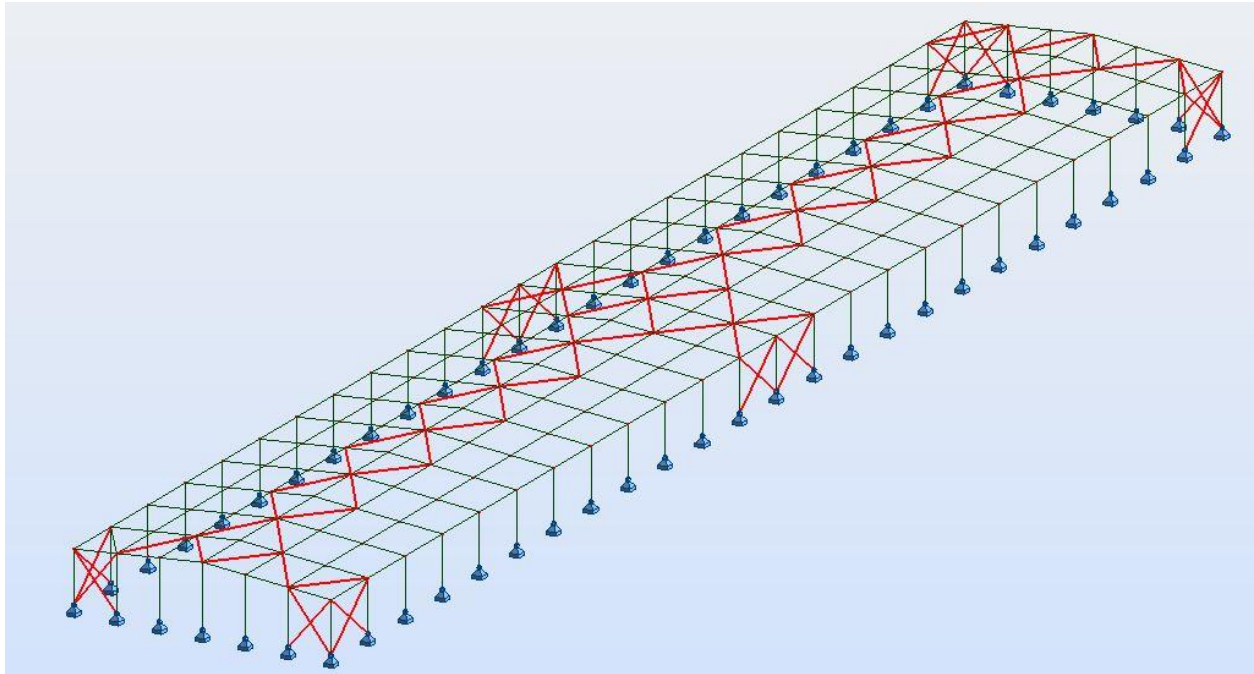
Modelo do contraventamento a utilizar na estrutura
